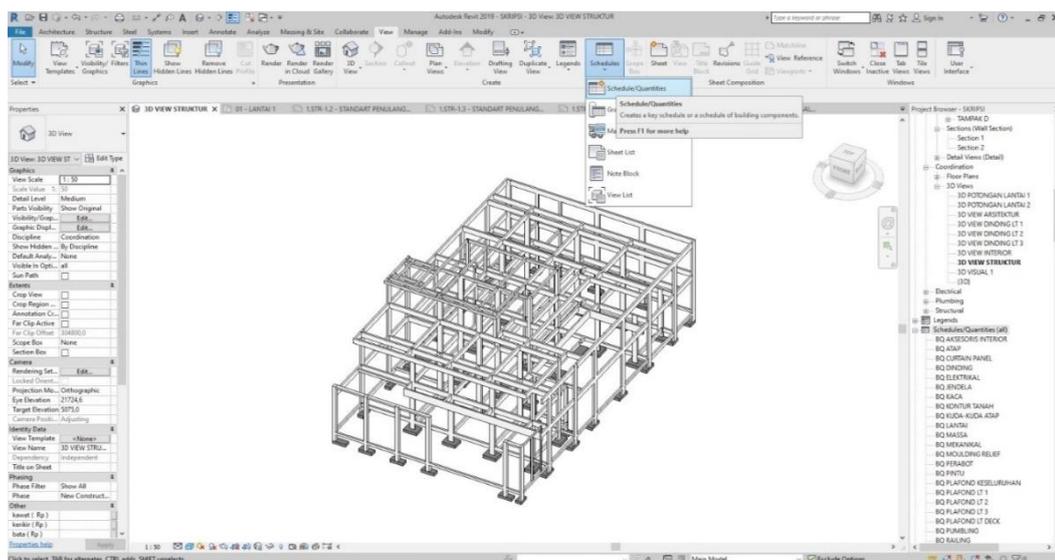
Tampilan Memasukkan Struktur Pelat Lantai Kedalam Permodelan
